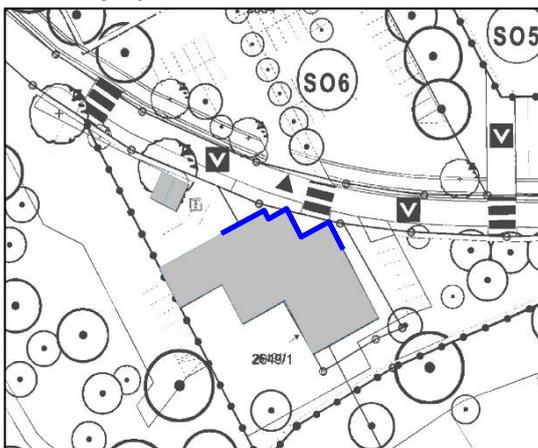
Darstellung der Fassadenbereiche mit Empfehlung für passive Schallschutzmaßnahmen bei Neu- und Ersatzbauten
